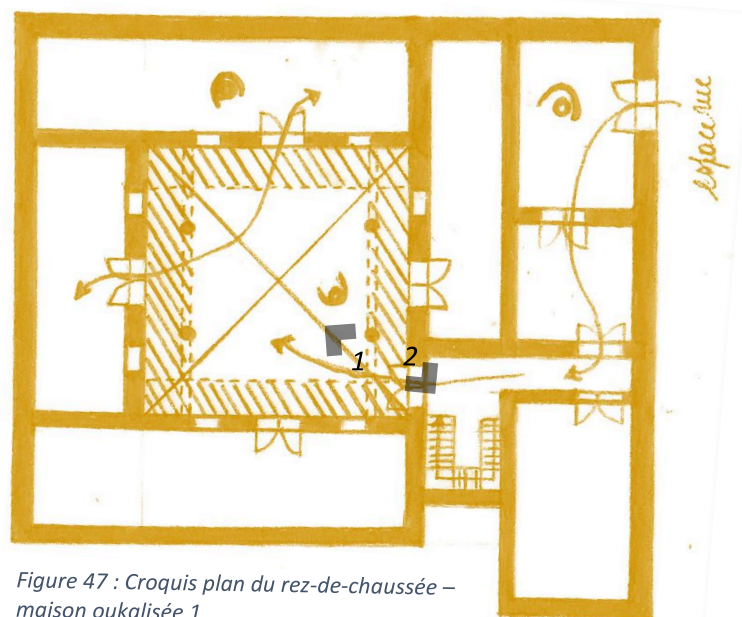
Croquis plan du rez-de-chaussée – maison oukalisée 1.
